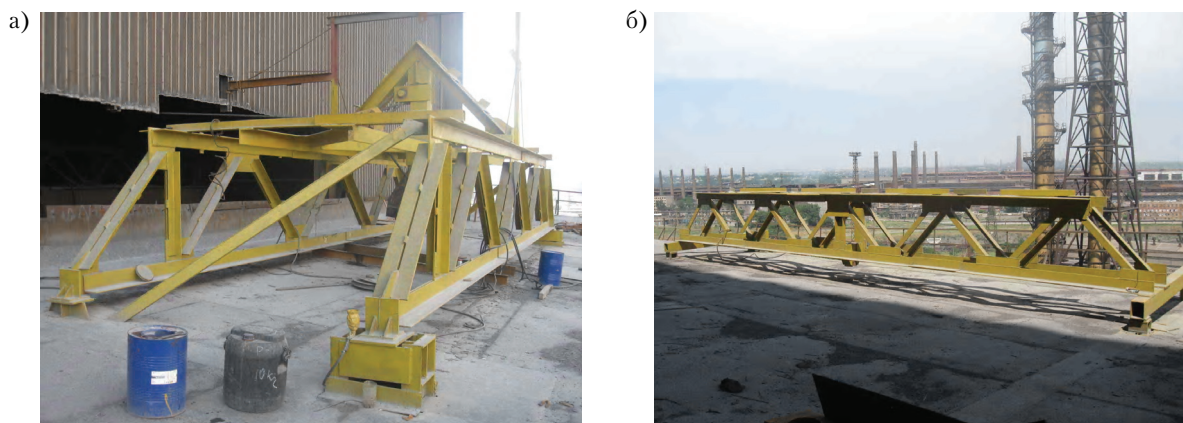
Монтажные конструкции, установленные на существующие смежные стропильные фермы: а) монтажная ферма пролетом 3 м, установленная на две вспомогательные фермы пролетом 12 м (грузоподъемность 70 т); б) монтажная решетчатая балка пролетом 12 м установленная на две вспомогательные балки пролетом 3 м (грузоподъемность 30 т).
